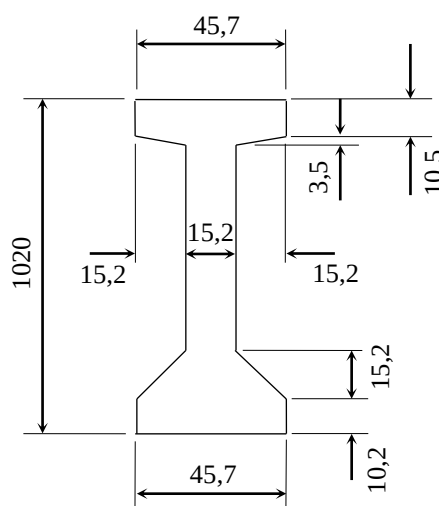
Dimensões (mm) da seção transversal da viga I.
